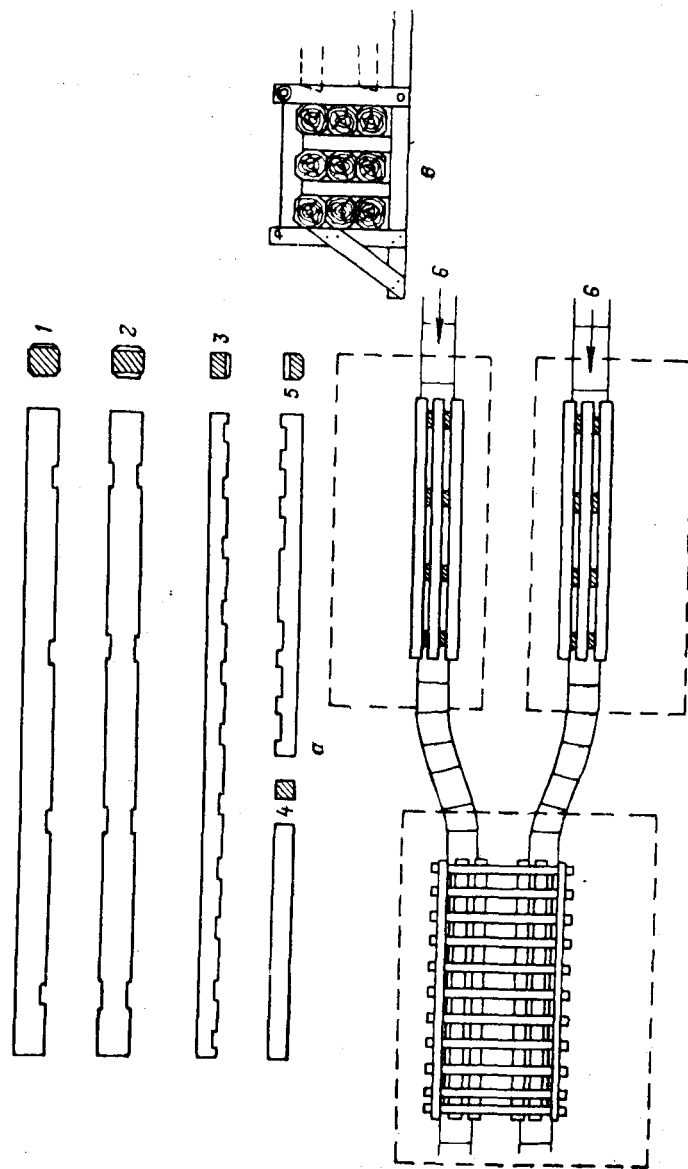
Схема площадки для сборки деревянного пакетного пролетного строения длиной 5,1 м:
